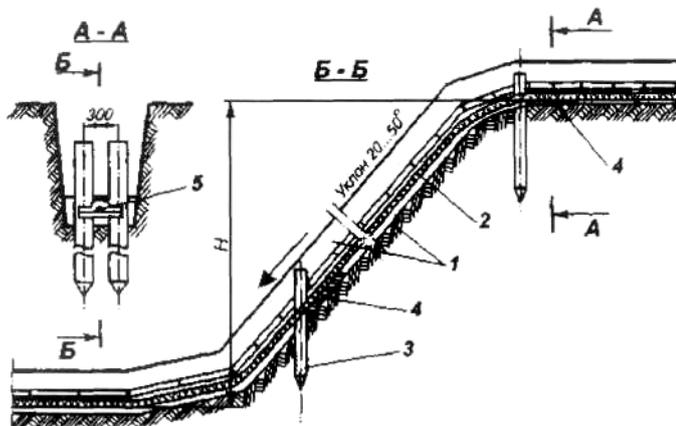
Крепление кабеля на размываемых ливнями и талыми водами склонах с уклоном от 20 до 50°: 1 – просевший грунт или песок; 2 – кирпич или плиты; 3 – свая железобетонная; 4 – плита асбоцементная; 5 – скоба для крепления кабеля
